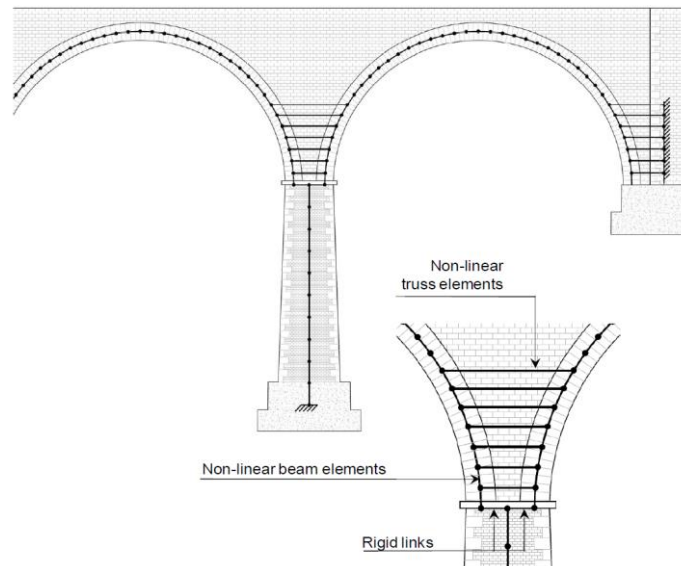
Schema di modellazione attraverso elementi a fibre di un ponte ad arco in muratura. [141]
